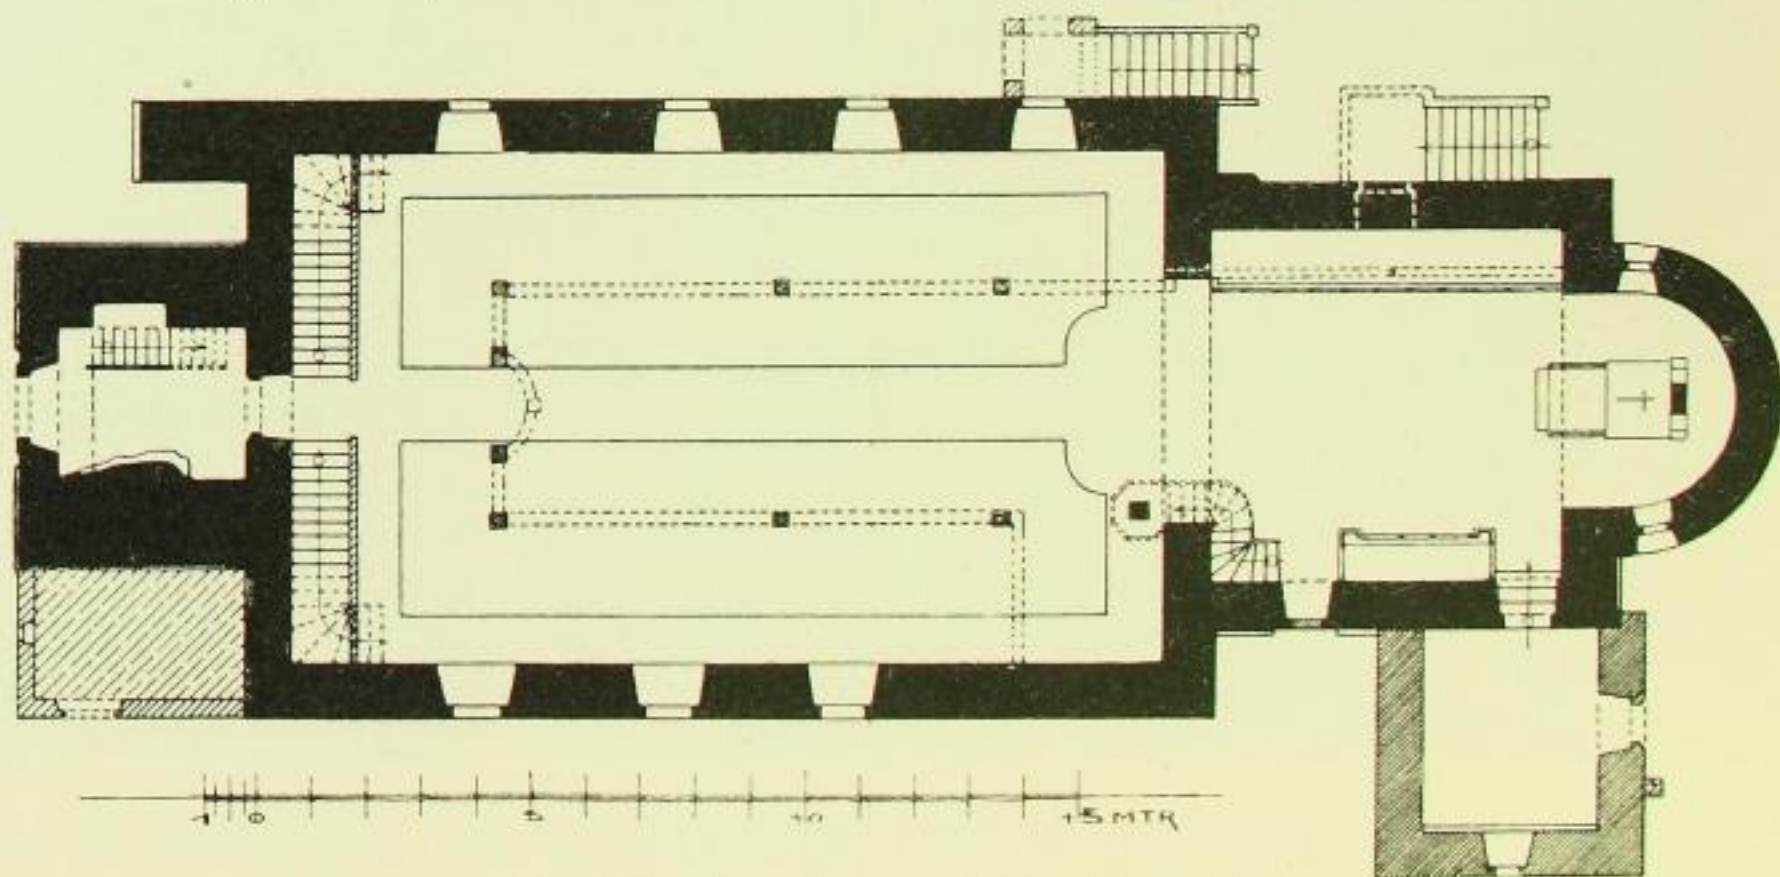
Lorenzkirch, Kirche, Grundriß.
